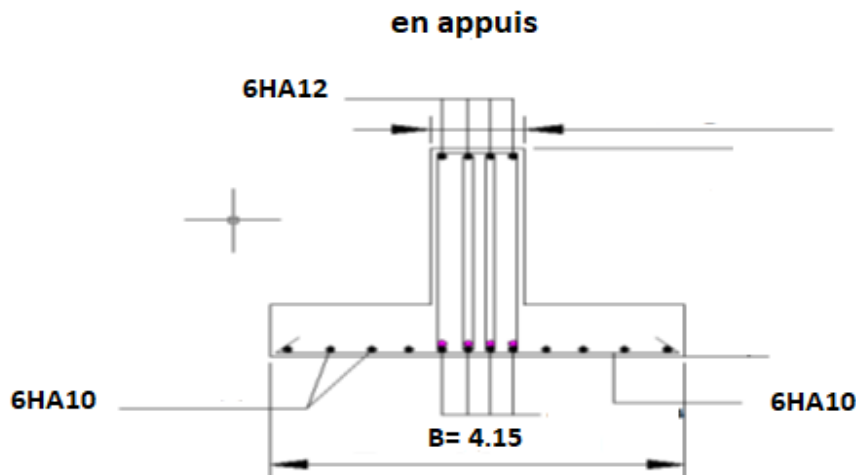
ferrailage de la semelle filante sous poteau en appui
